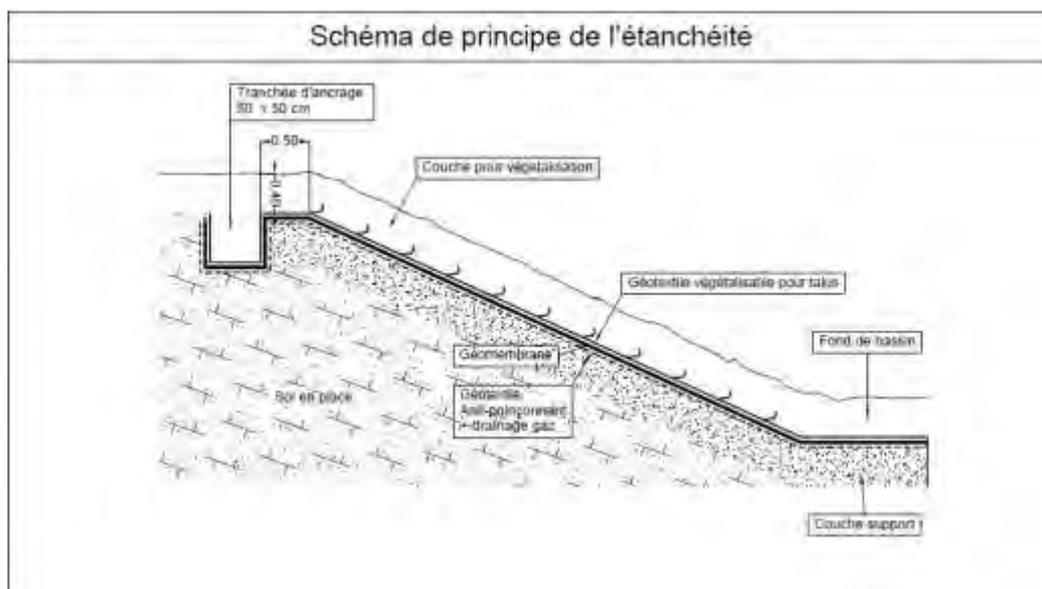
Schéma de principe de l'étanchéité du bassin du 1^{er} étage du bassin de rétention n°1
